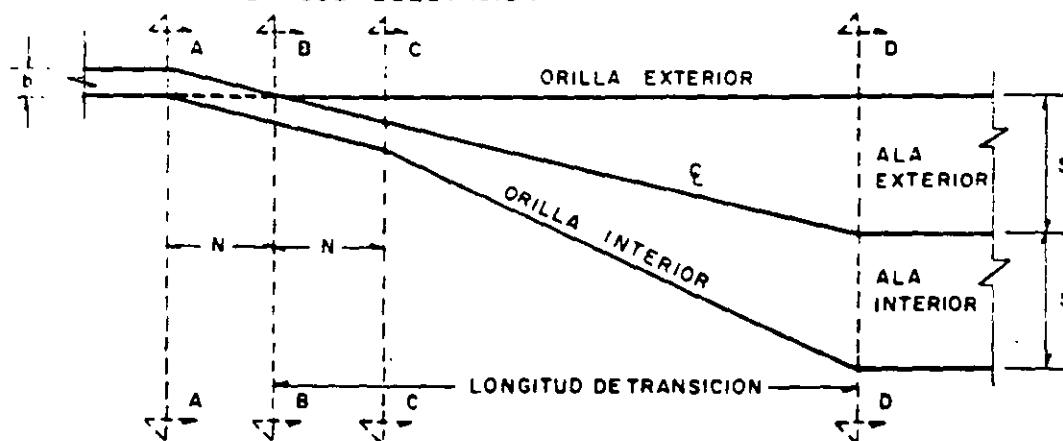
TRANSICION DE LA SECCION EN TANGENTE A LA SECCION EN CURVA GIRANDO SOBRE UNA ORILLA DE LA CORONA
